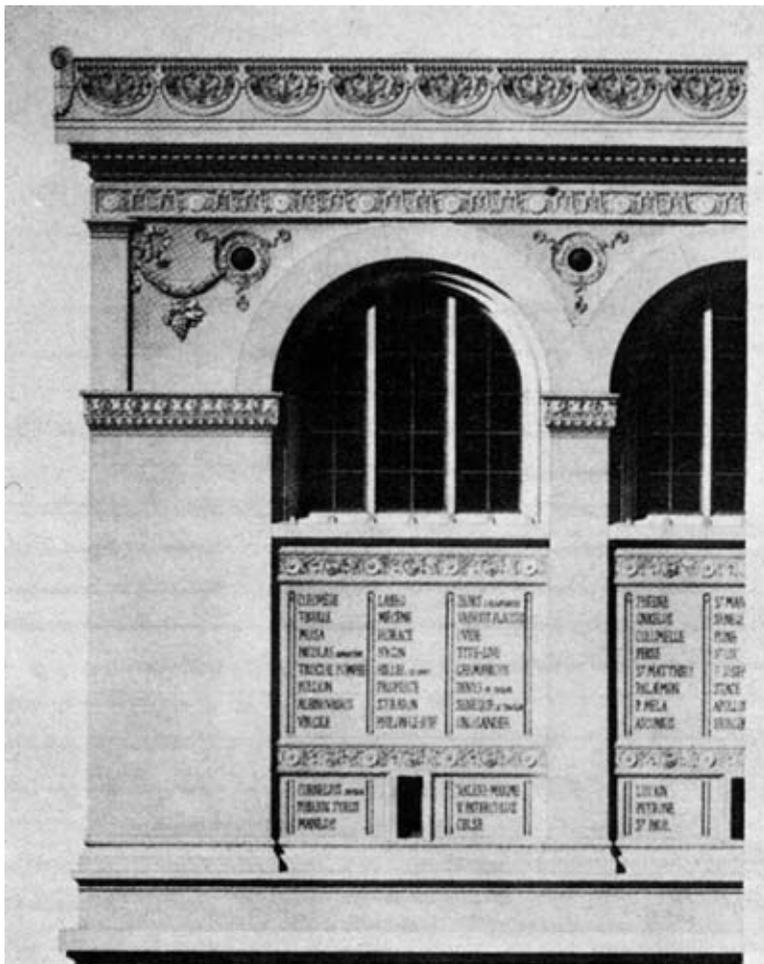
Particolare del prospetto della Biblioteca Ste-Geneviève
